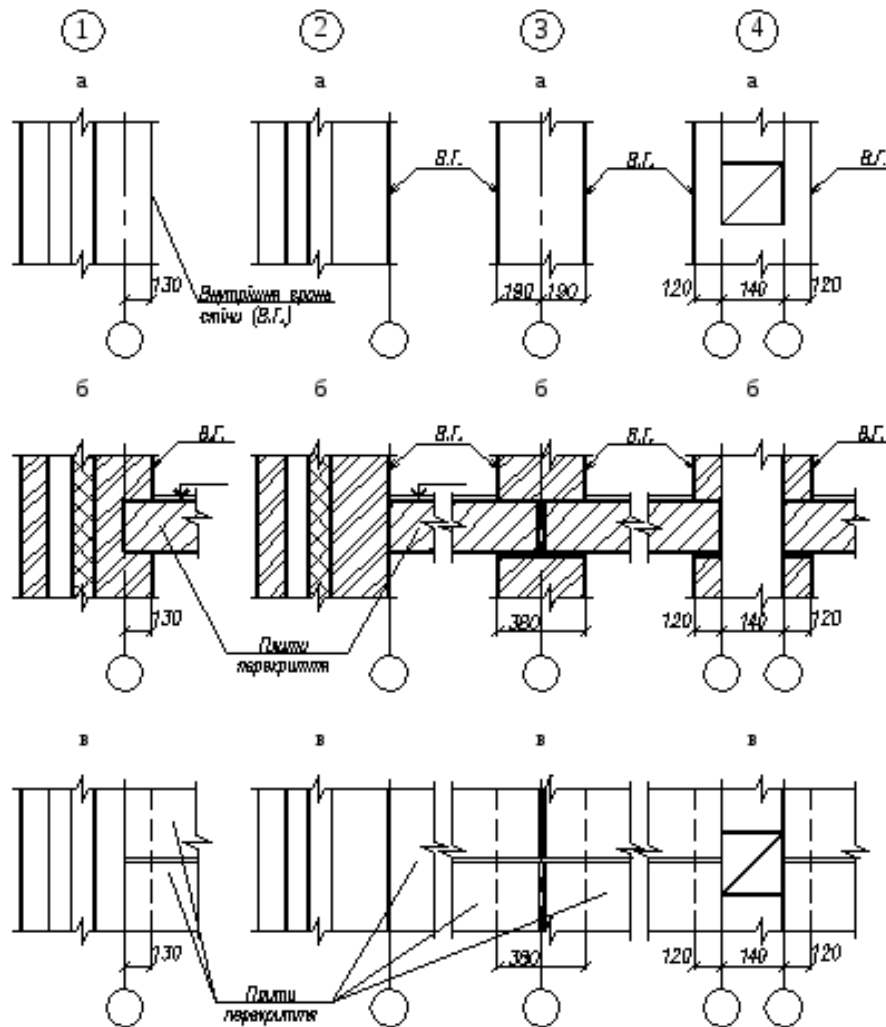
Прив'язки основних будівельних конструкцій будинків зі стінами з цегли до координатних осей: 1 – зовнішні несучі стіни; 2 – зовнішні самонесучі стіни; 3 – внутрішні несучі стіни; 4 – внутрішні несучі стіни з вентиляційними каналами.
